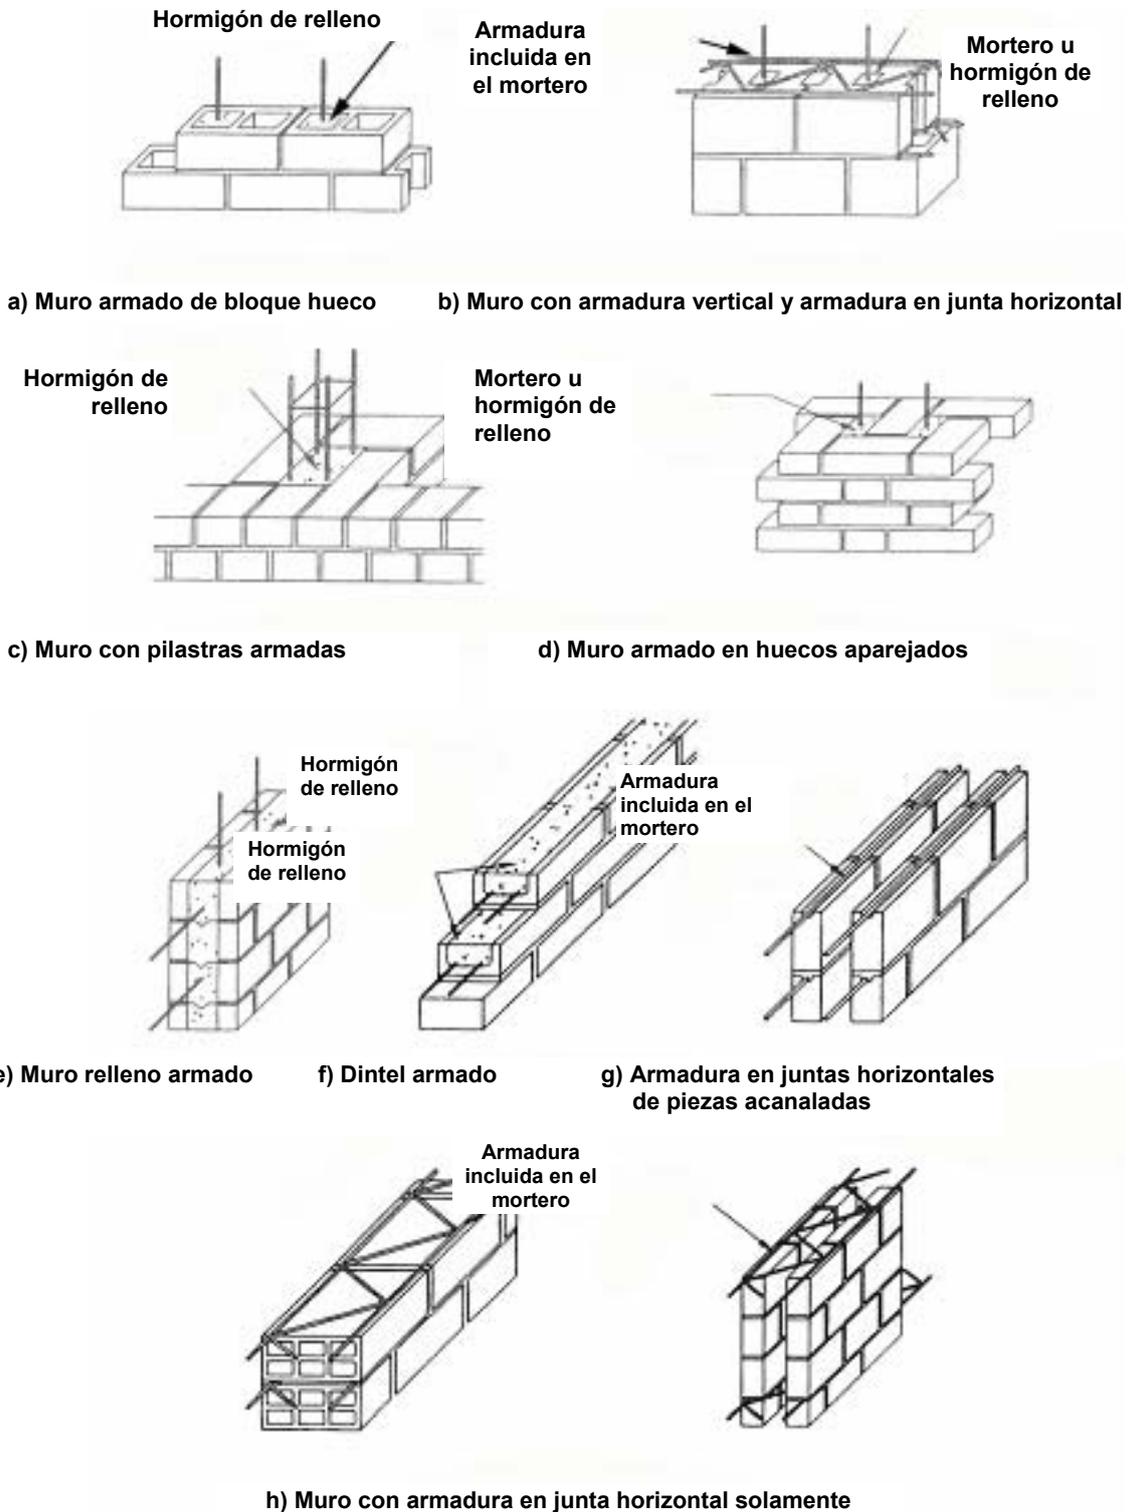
Ejemplos de disposiciones de armado en mampostería
